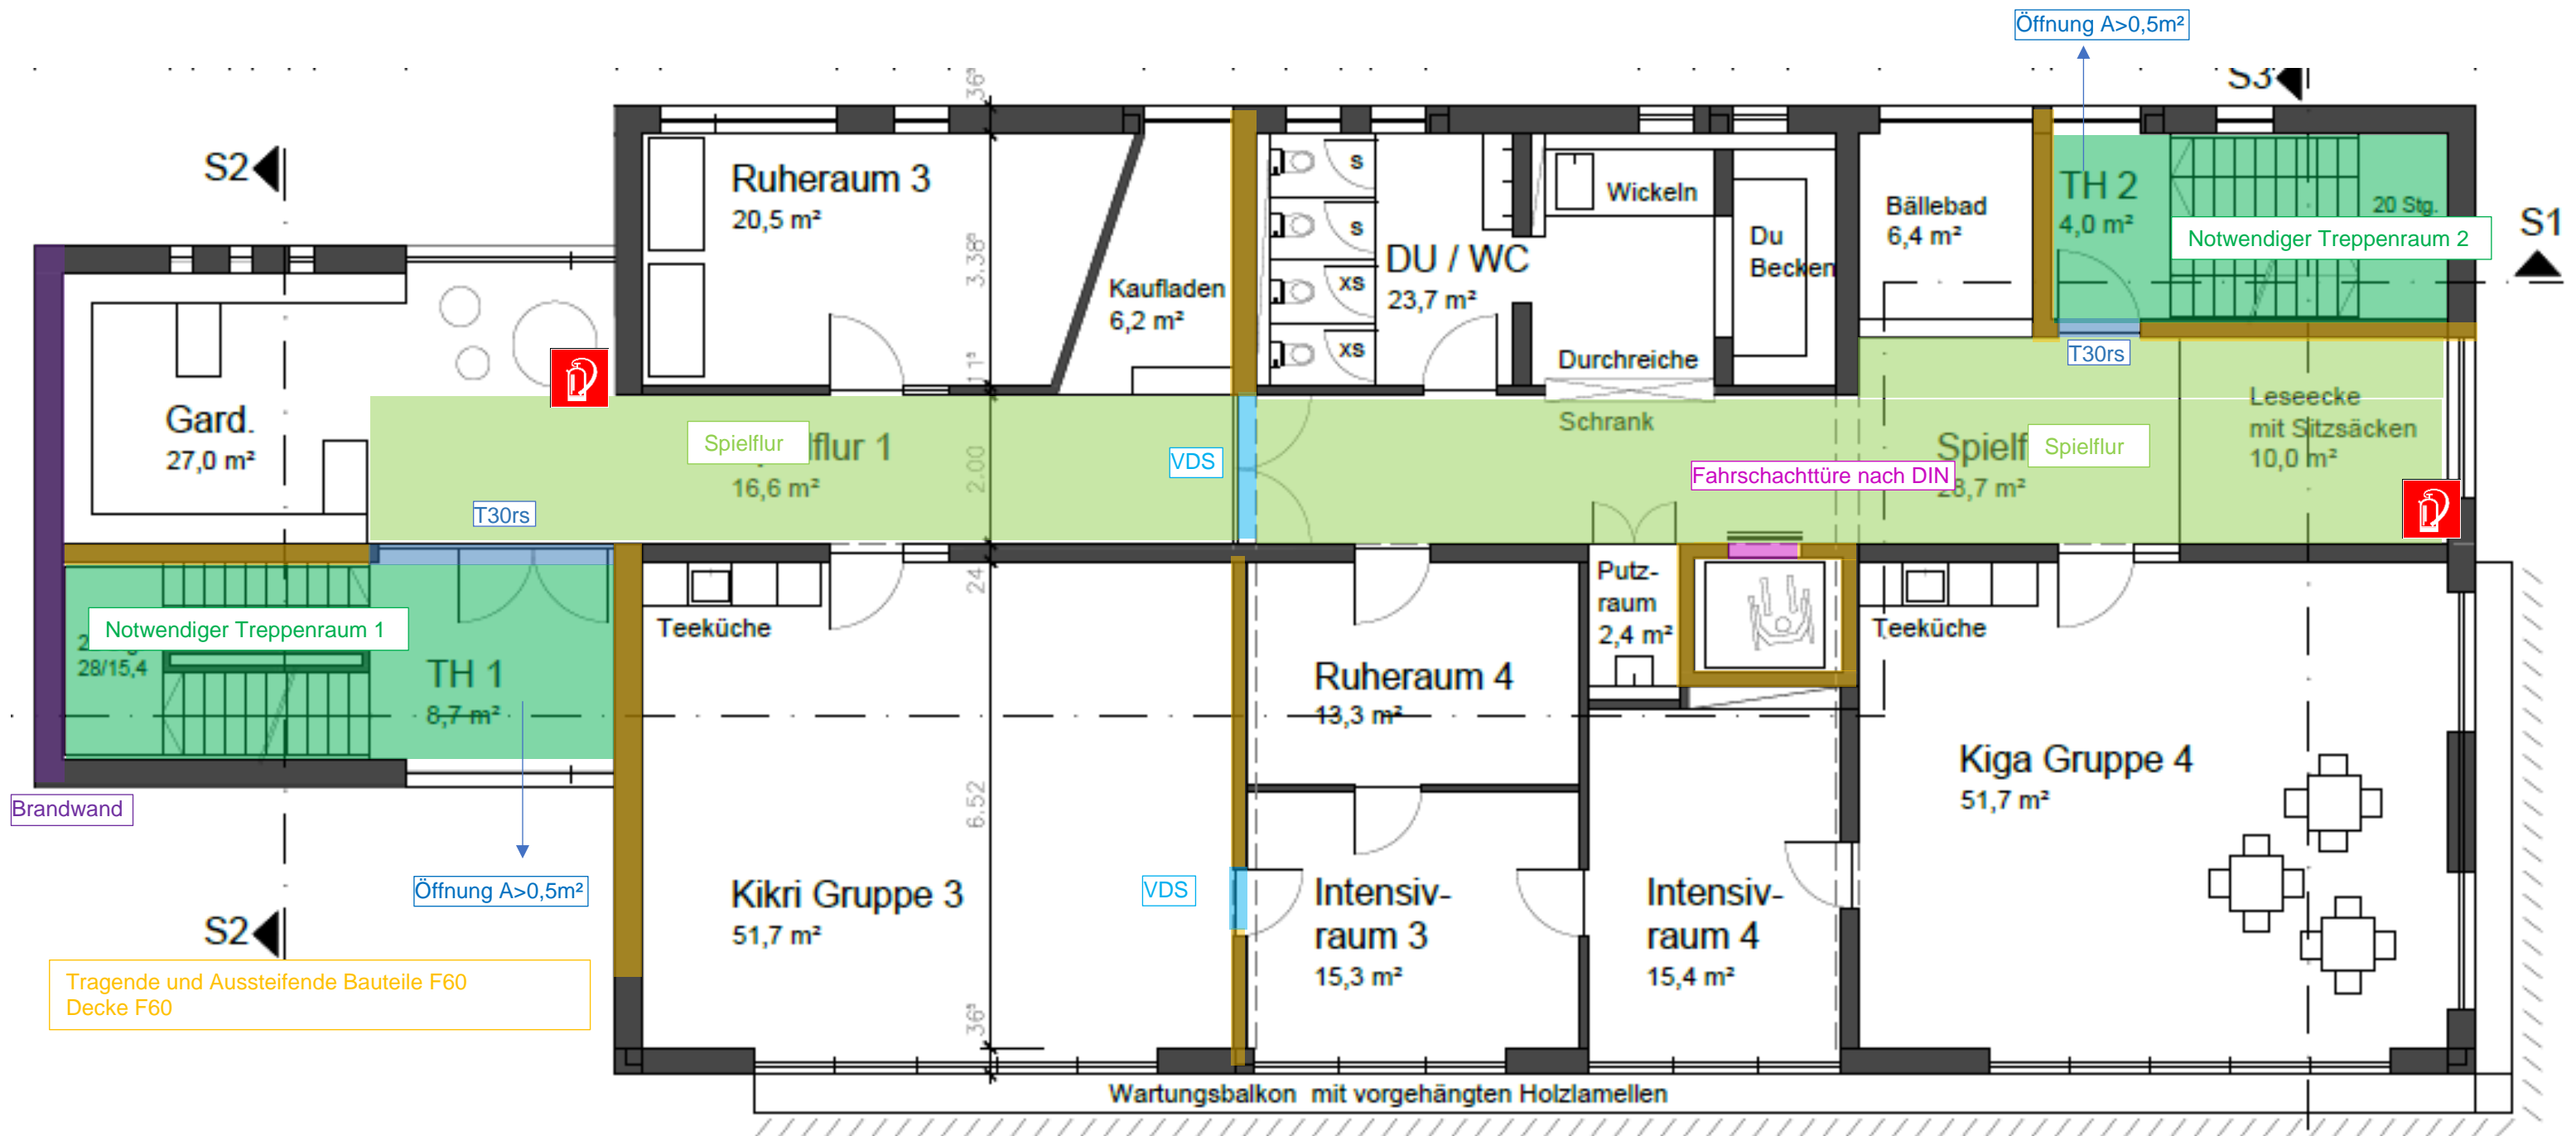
Grundriss 1. Obergeschoss
